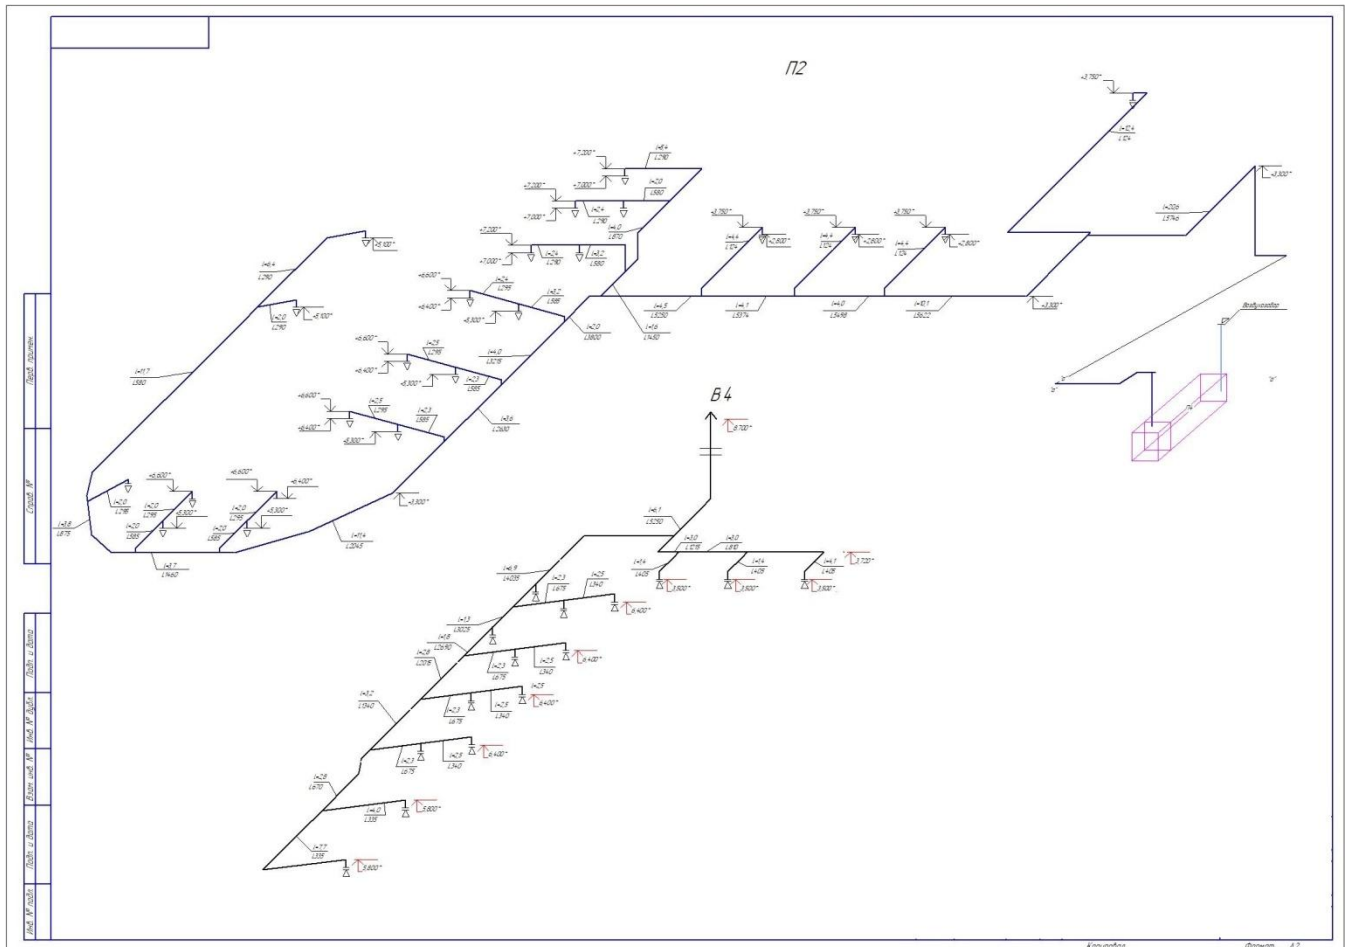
расчетная схема системы вентиляции в помещении кафе
